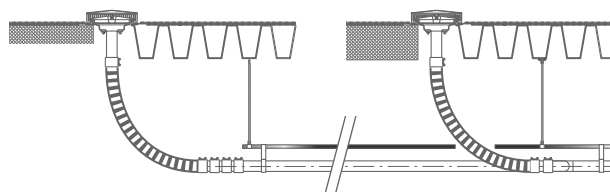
Монтаж соединительной трубки flexibles с высотой свешивания > 0,6 м
